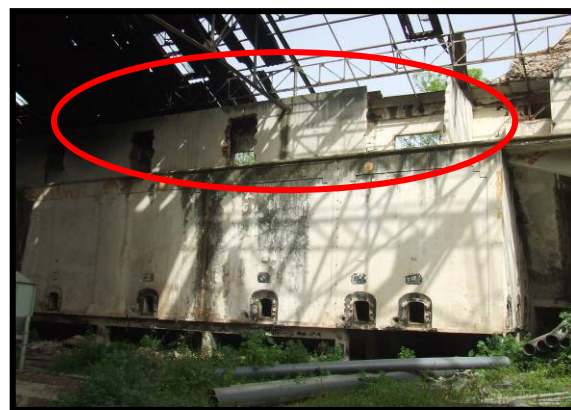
Bureaux de gestion de la C.O.F.L sur la dalle des cuves à vin
